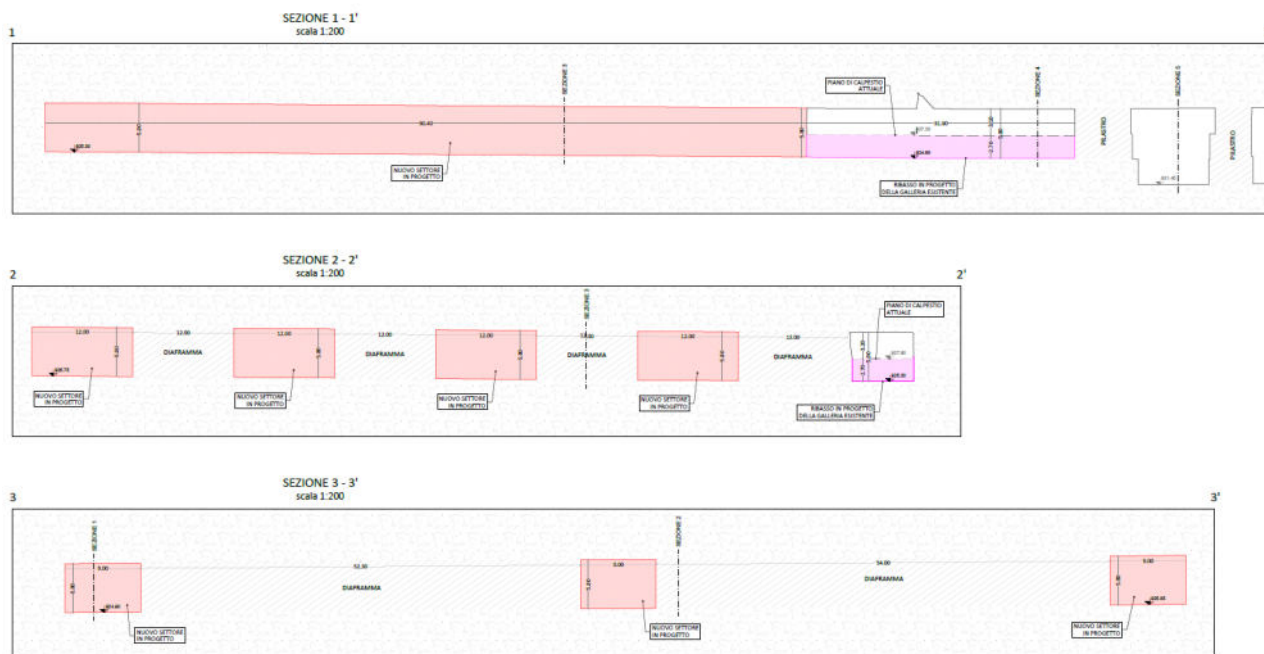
Stralcio di sezioni di progetto con indicazione dello stato attuale e della sagoma di avanzamento.
